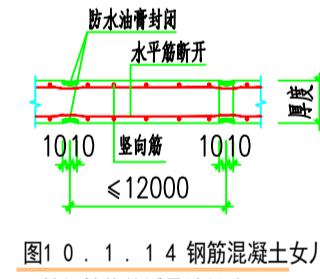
钢筋混凝土女儿墙、挂板等构件诱导缝做法
